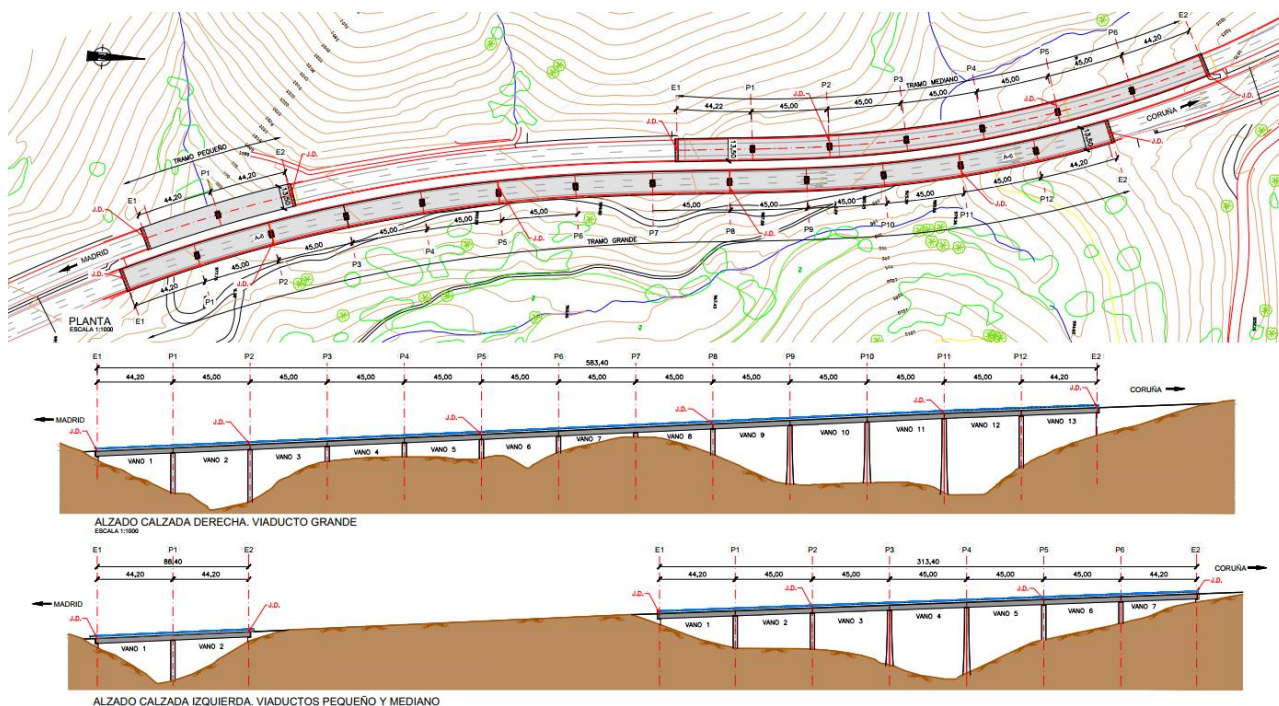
Planta y alzado de los viaductos del Castro. (Fuente: [5]).
